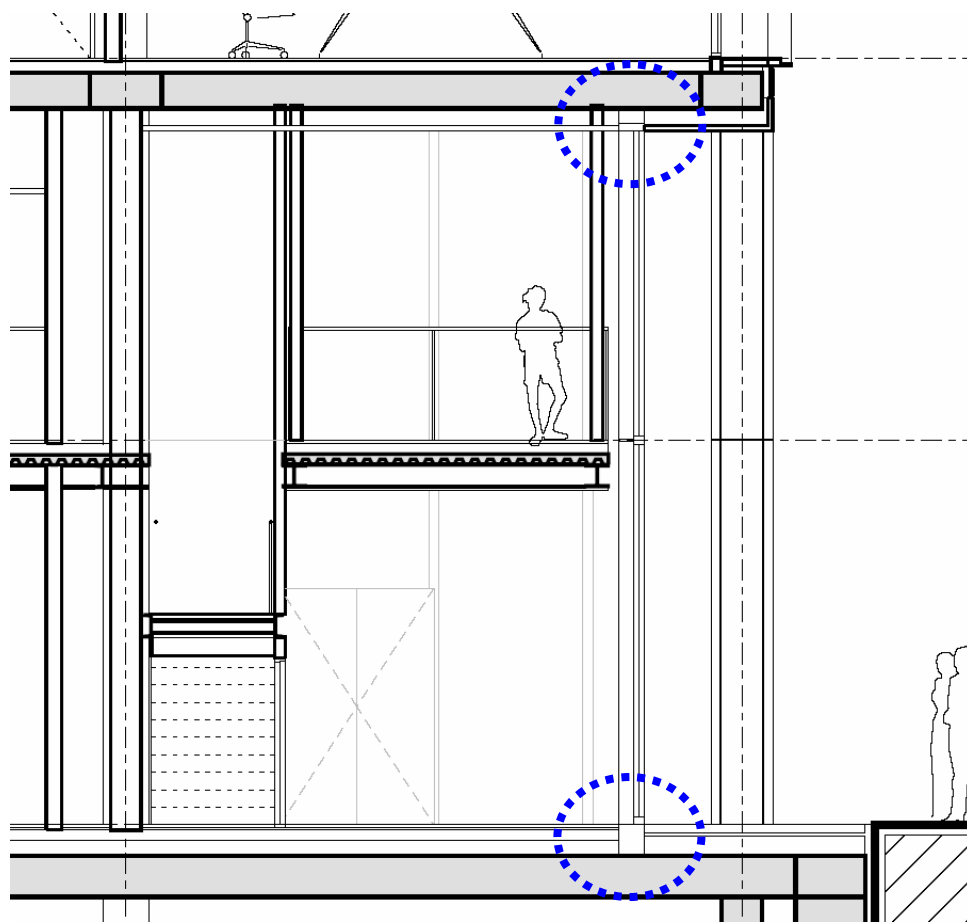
Indicazione in sezione degli elementi leggeri di facciata non rigidamente connessi
